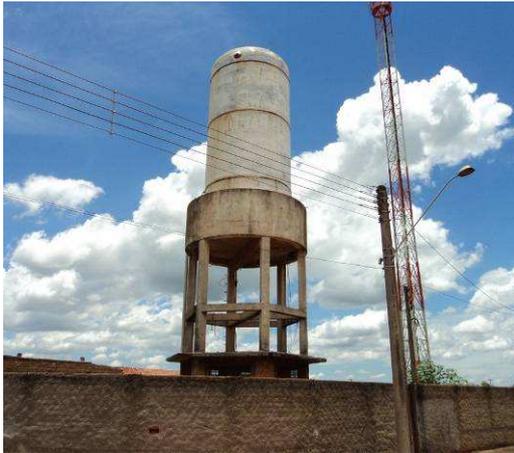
Vista geral do reservatório elevado do Jd. Santa Marta.
